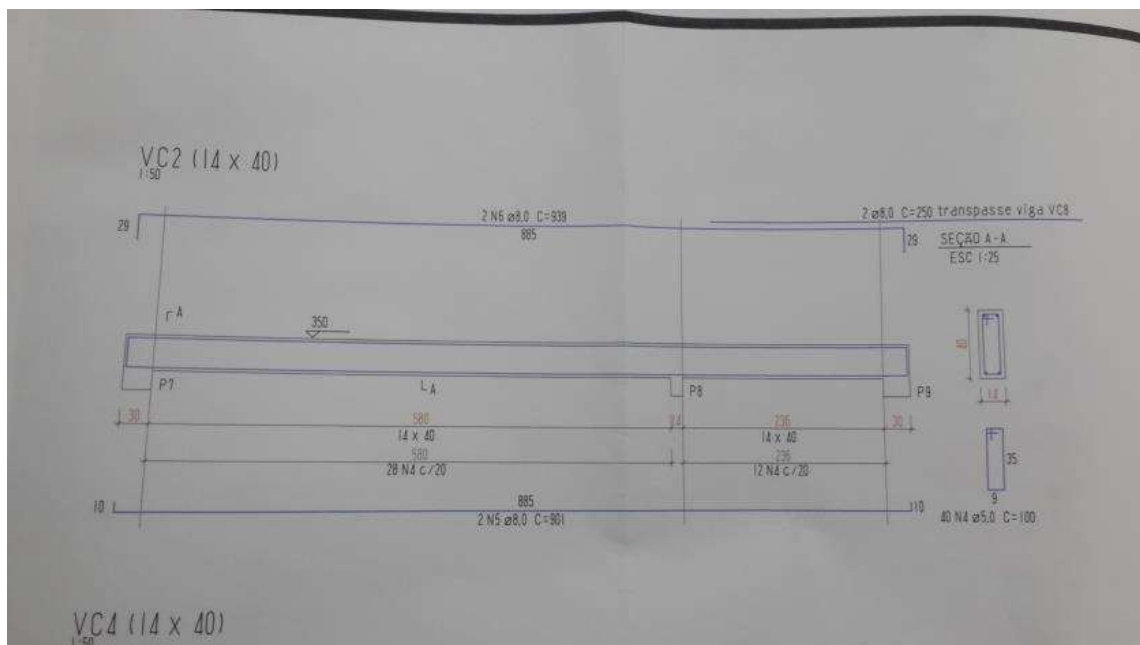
Projeto 12/13 - detalhamento da viga de cobertura VC 02.
